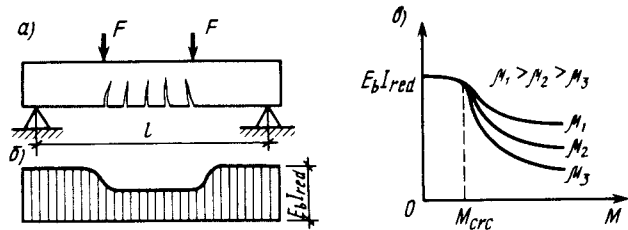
Влияние трещин и коэффициента армирования на жесткость железобетонной балки
